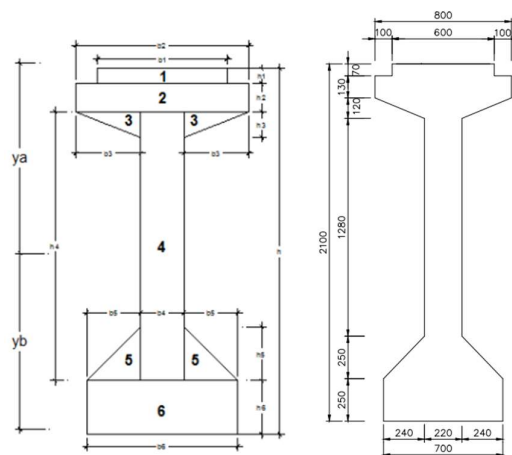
Potongan Melintang Jembatan Eksisting *PCI Girder
